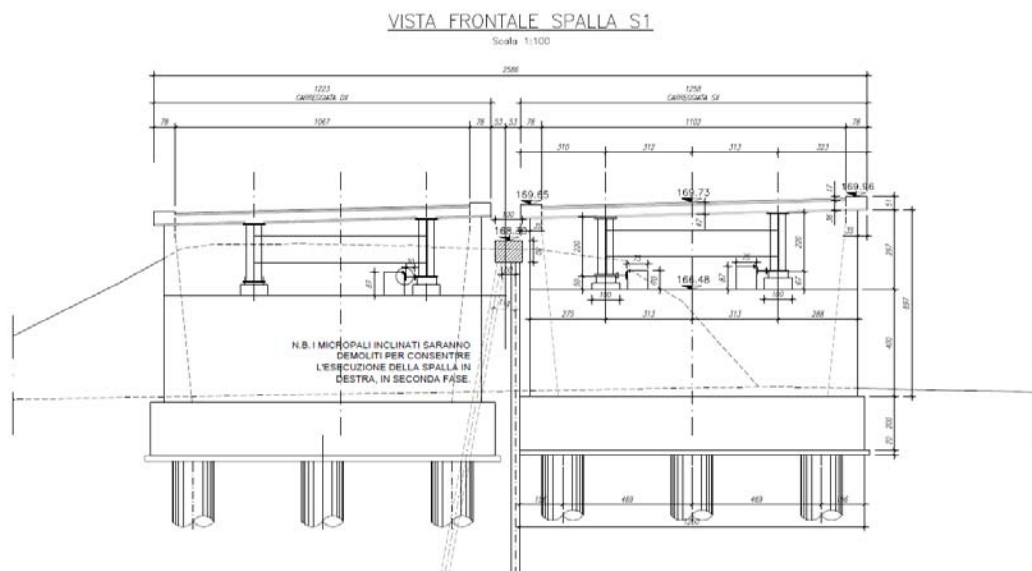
Sezione trasversale spalle Viadotto sul fiume Merse
